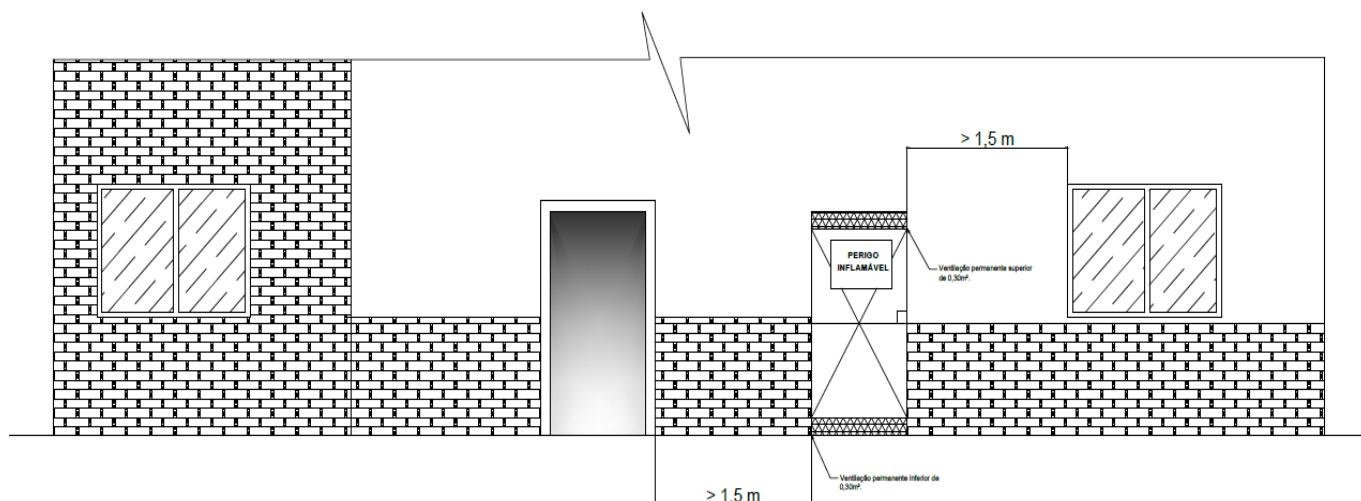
Detalhe em fachada de uma central de gás em nicho.
